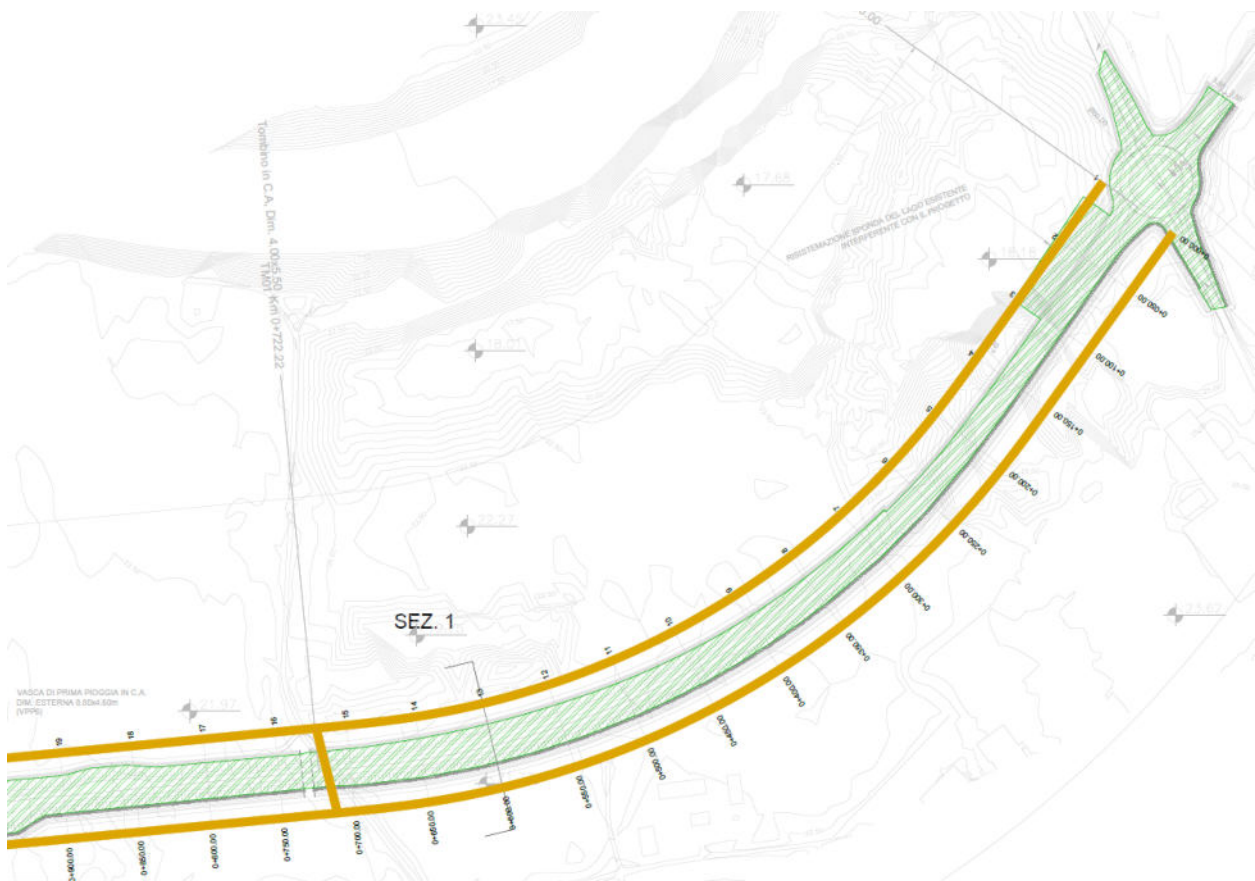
Stralcio planimetria T00-GE01-GEO-CD02
